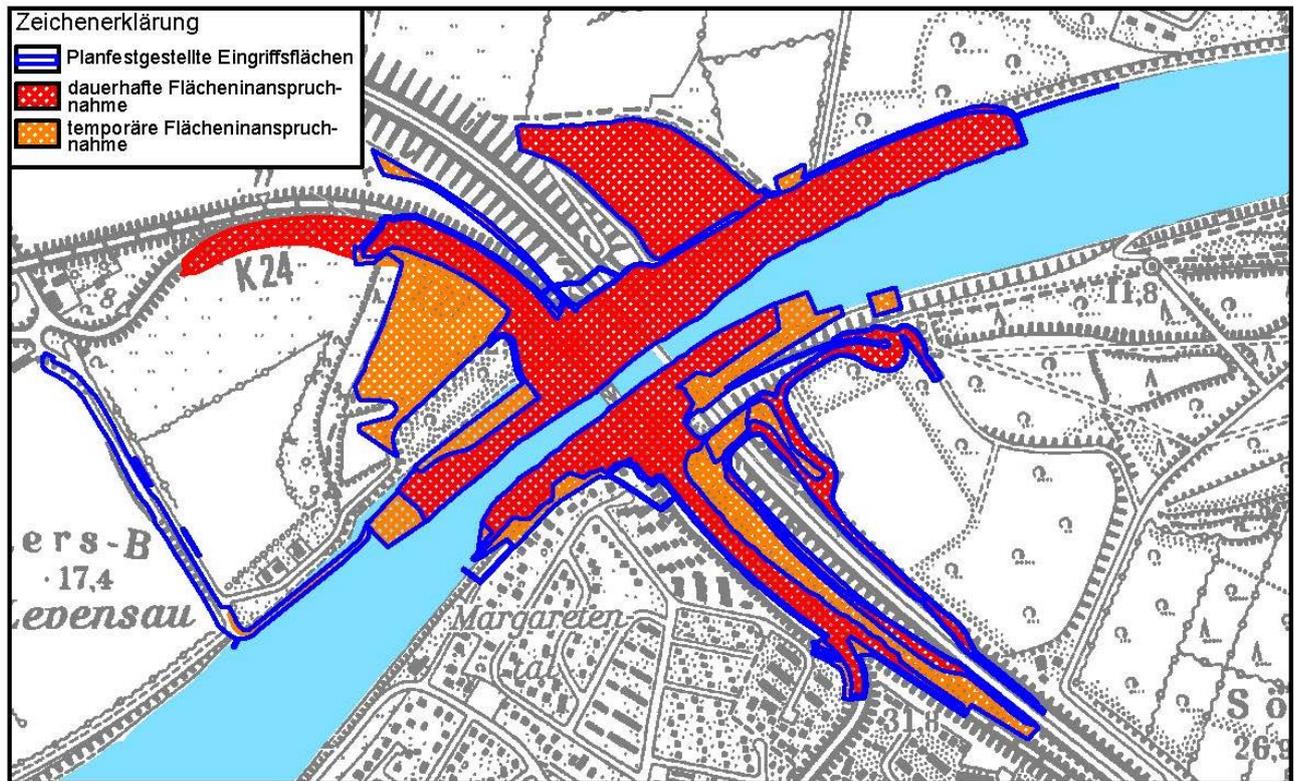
Überlagerung planfestgestellter Stand (blaue Umgrenzung) und Planänderung
